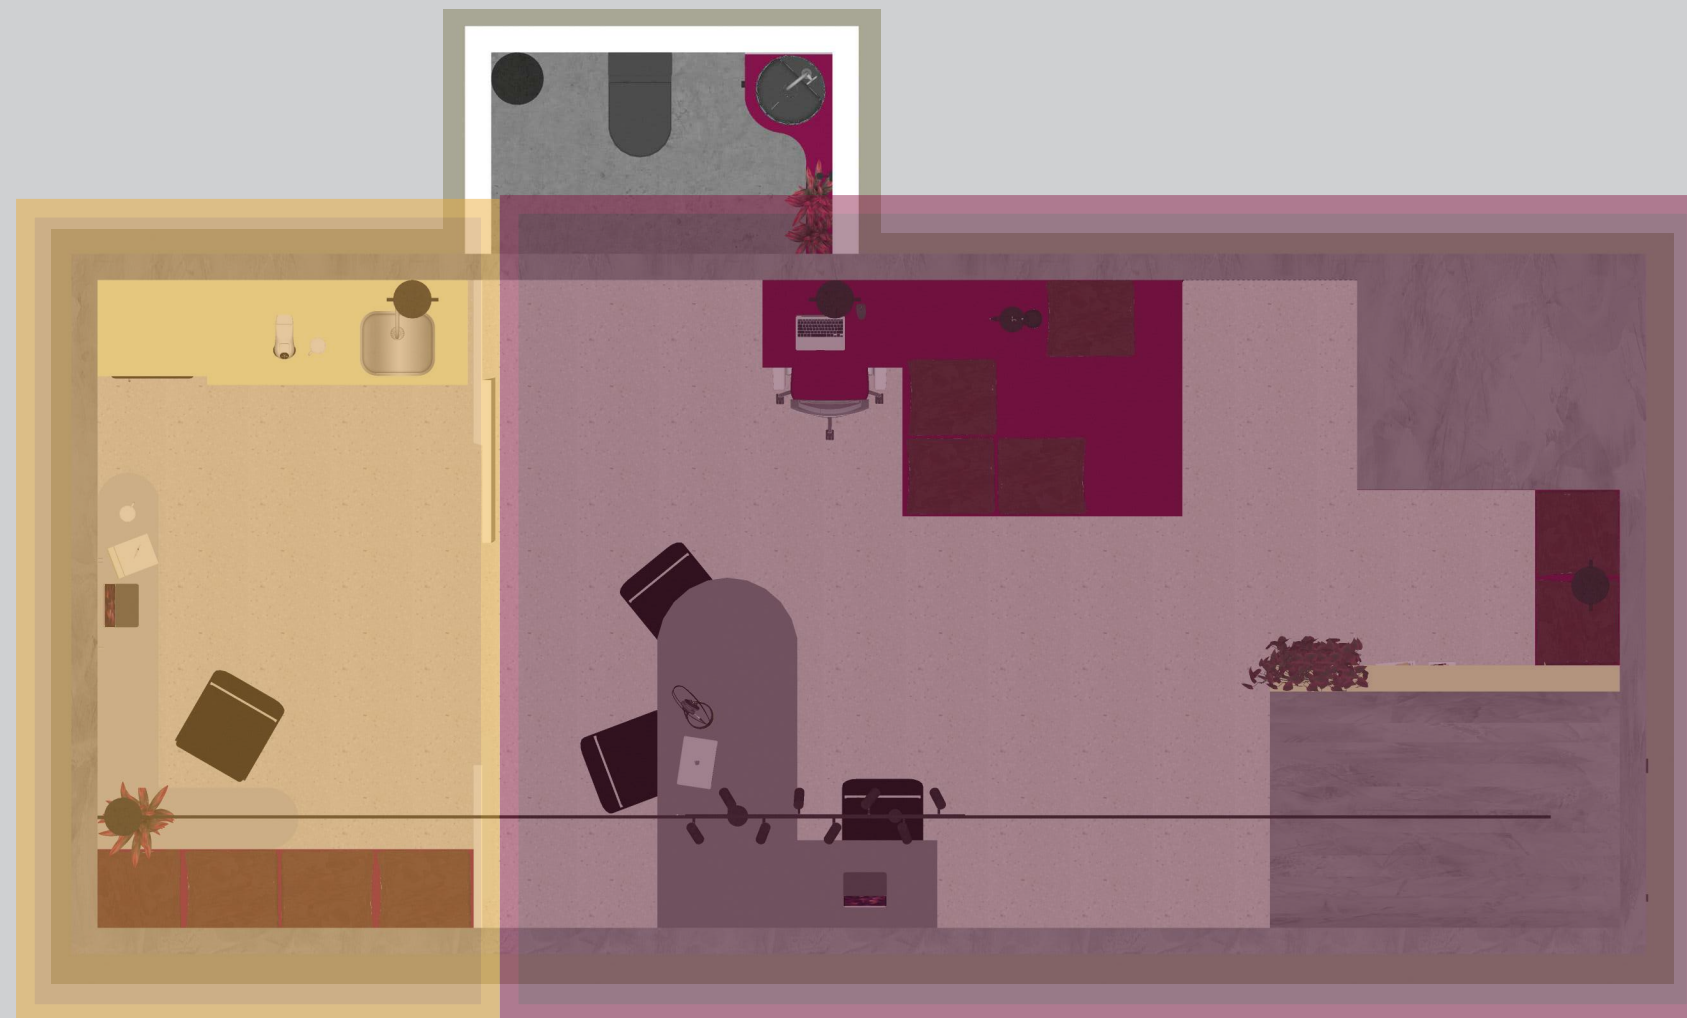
Layout Planta cotada – Fonte: Autoral .
